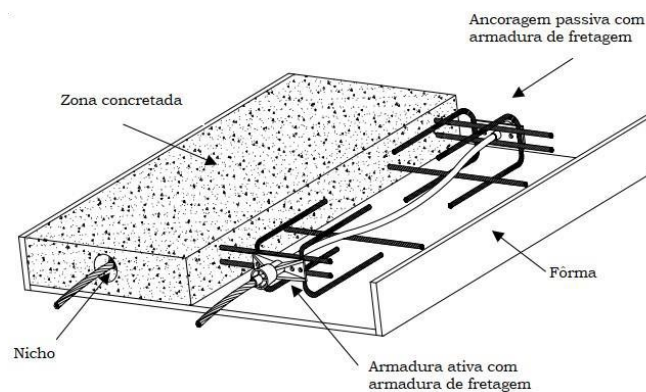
Esquema simplificado de protensão não aderente (ancoragem passiva, ativa e armadura de fretagem). Fonte: (ALMEIDA FILHO; 2002)
